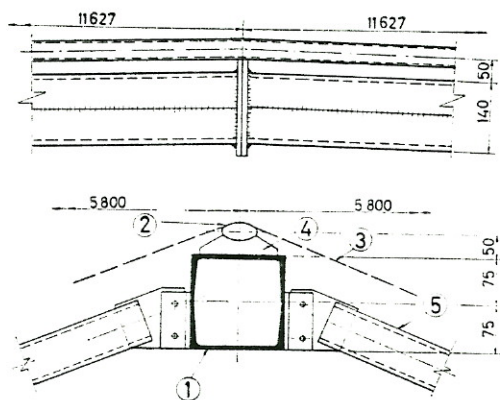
Sezione trasversale dell'arco in chiave. (1) Due UNP 180 collegati testa a testa. (2) Tubo ovale. (3) Membrana. (4) Sella d'appoggio. (5) Tubo stabilizzatore collegante un arco con l'altro onde assicurare la stabilità laterale.
